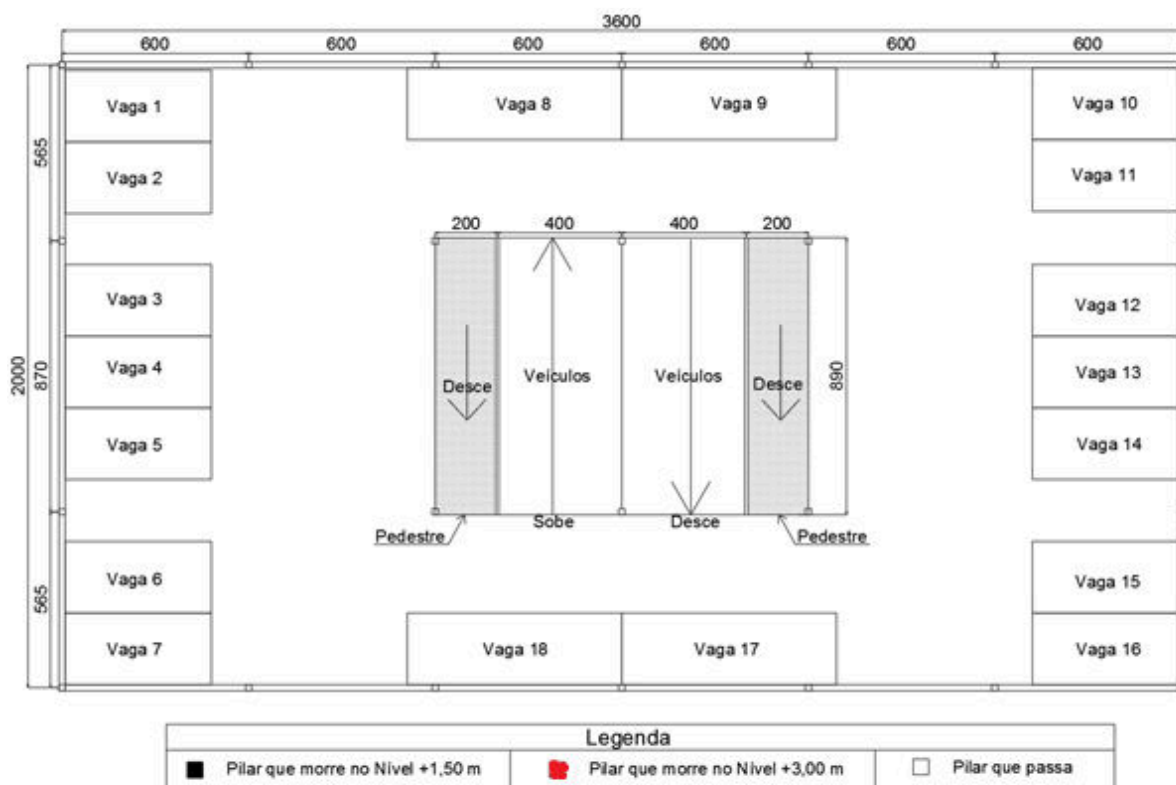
Arquitetura – Planta Baixa do 1º pavimento, nível +3,00 m.
